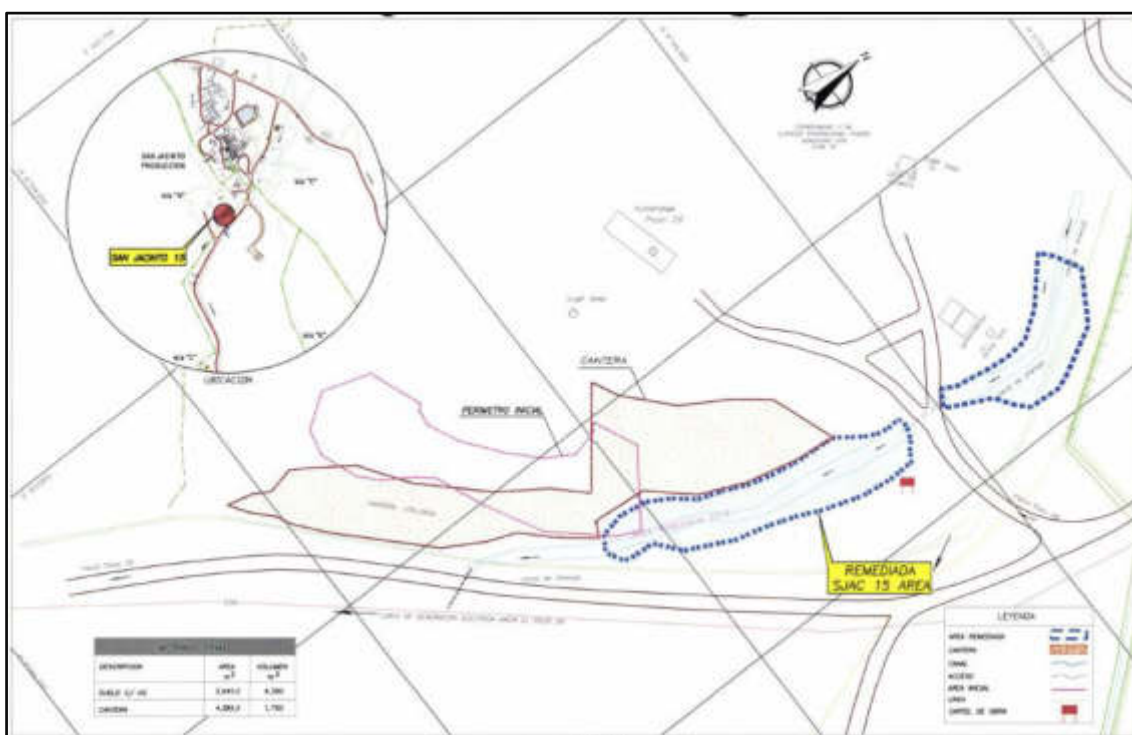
Plano de Planta General - Remediación del sitio PAC SJAC15
